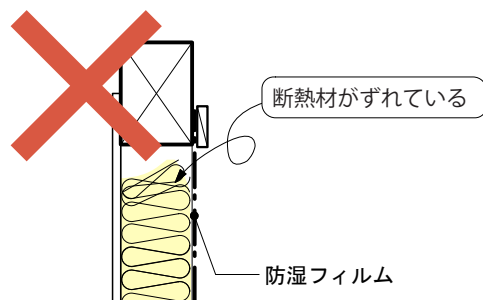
防湿フィルムの施工の悪い例 - 2
